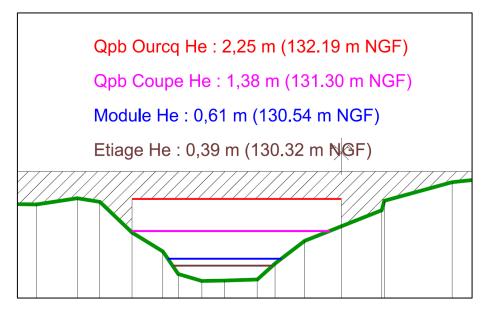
Profils en travers PT02 sur l'Ourcq aval (au droit du pont D809)
